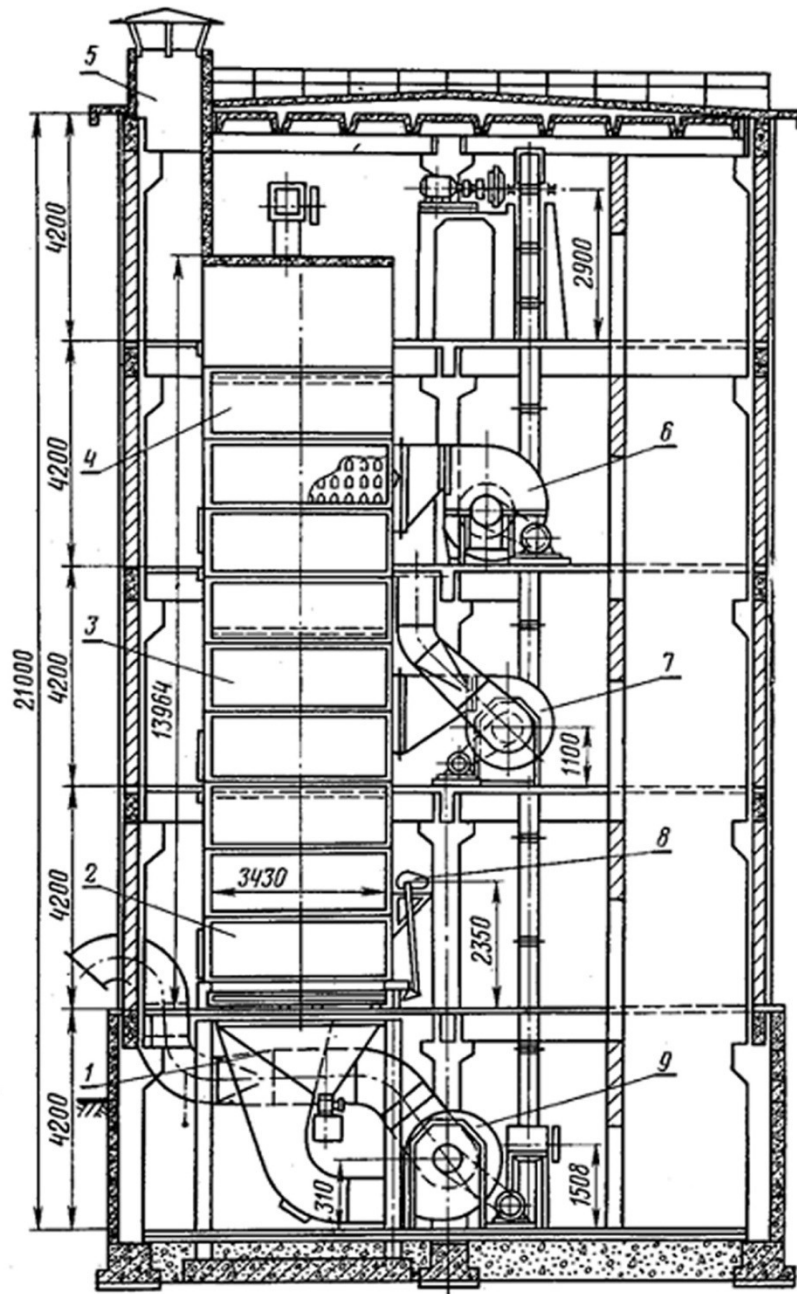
Загальний вид зерносушарки ДСП-32
